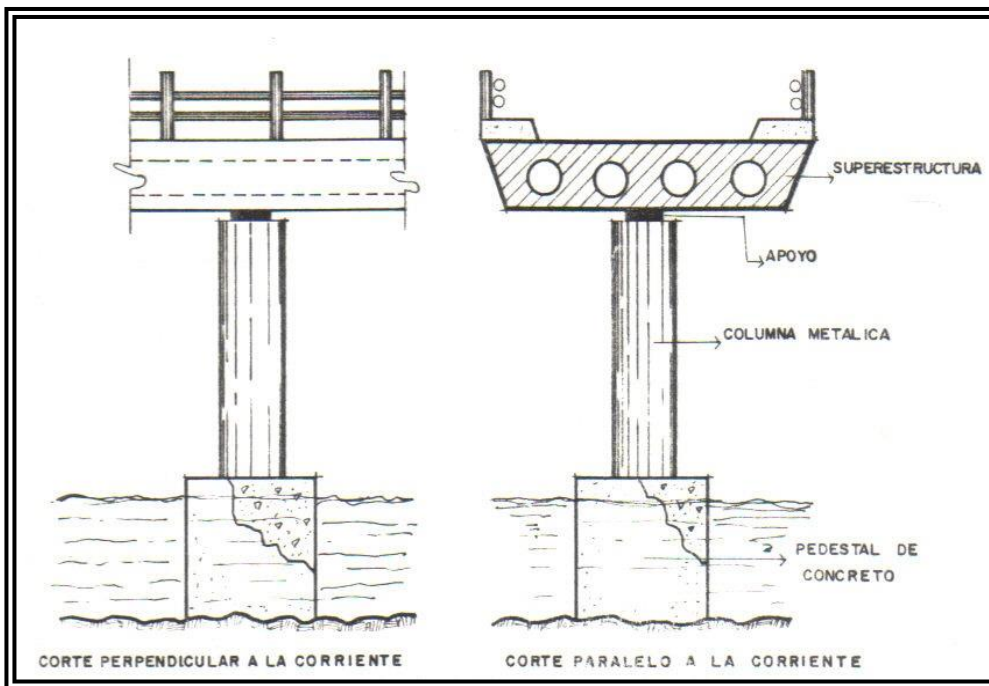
78 Pila tipo columna aislada¹⁰¹.
